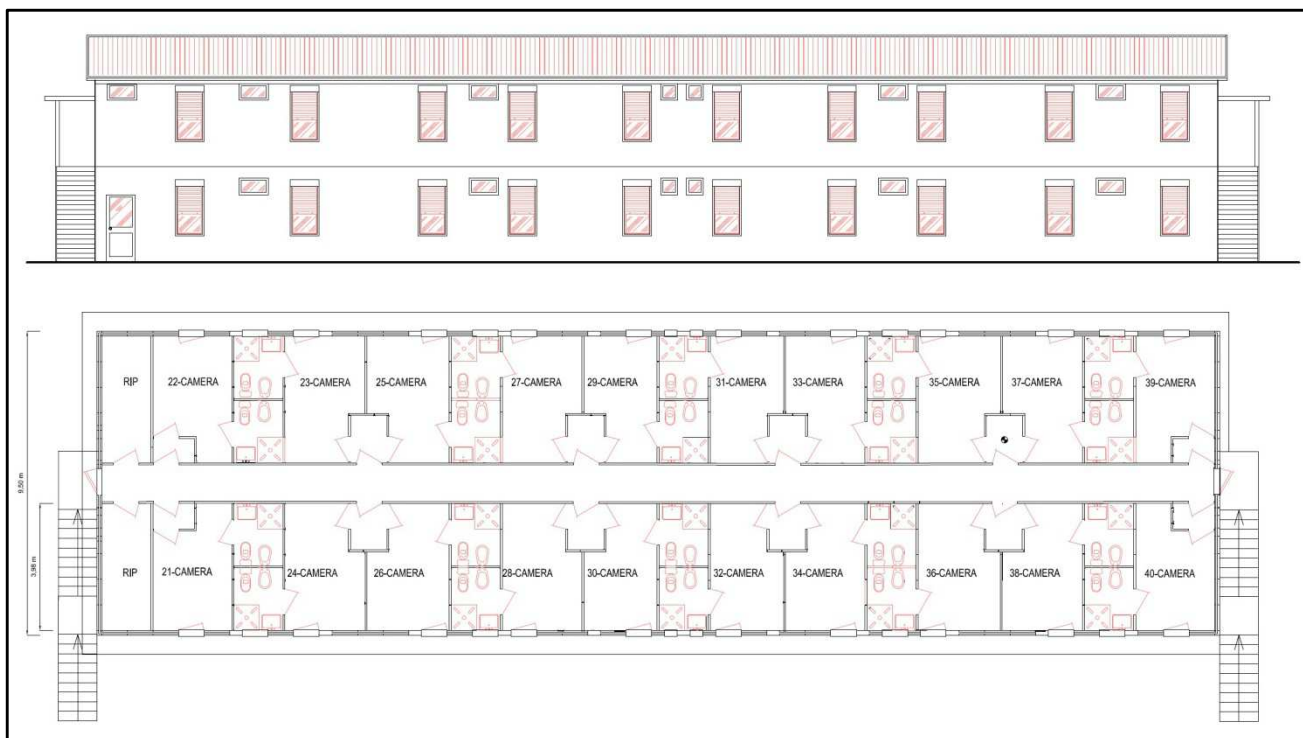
Prospetto e pianta tipo prefabbricato ad uso dormitorio
